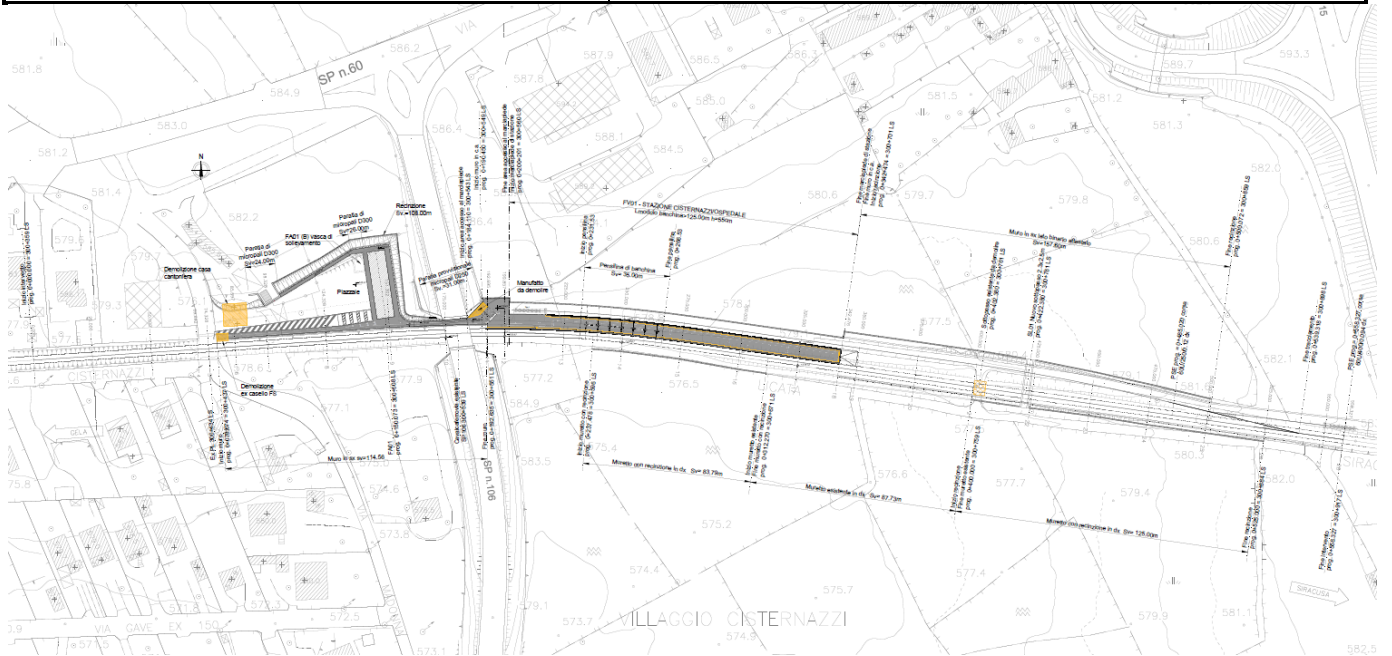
Planimetria di progetto nuova stazione Cisternazzi/Ospedale
